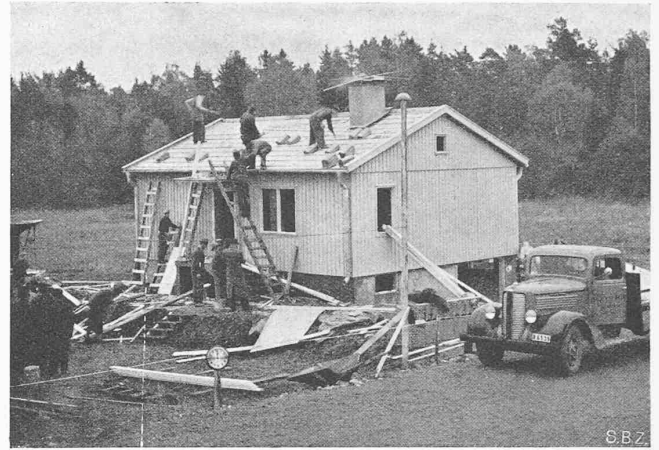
12 h: Dachdeckung, Heizung wird probiert
